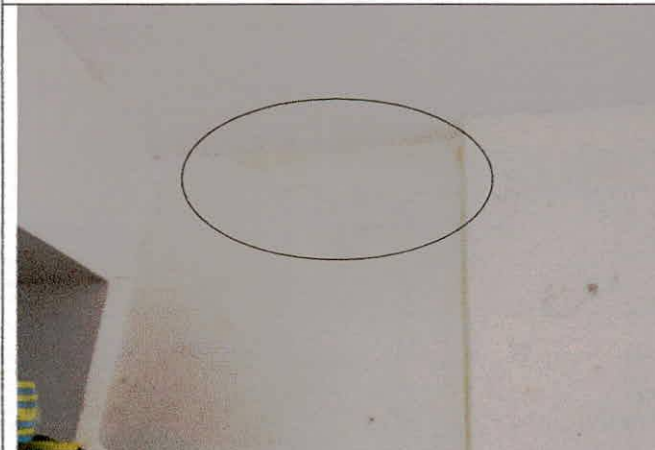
Fisura en la unión de columna con Muro de albañilería, MODULO N° 01
